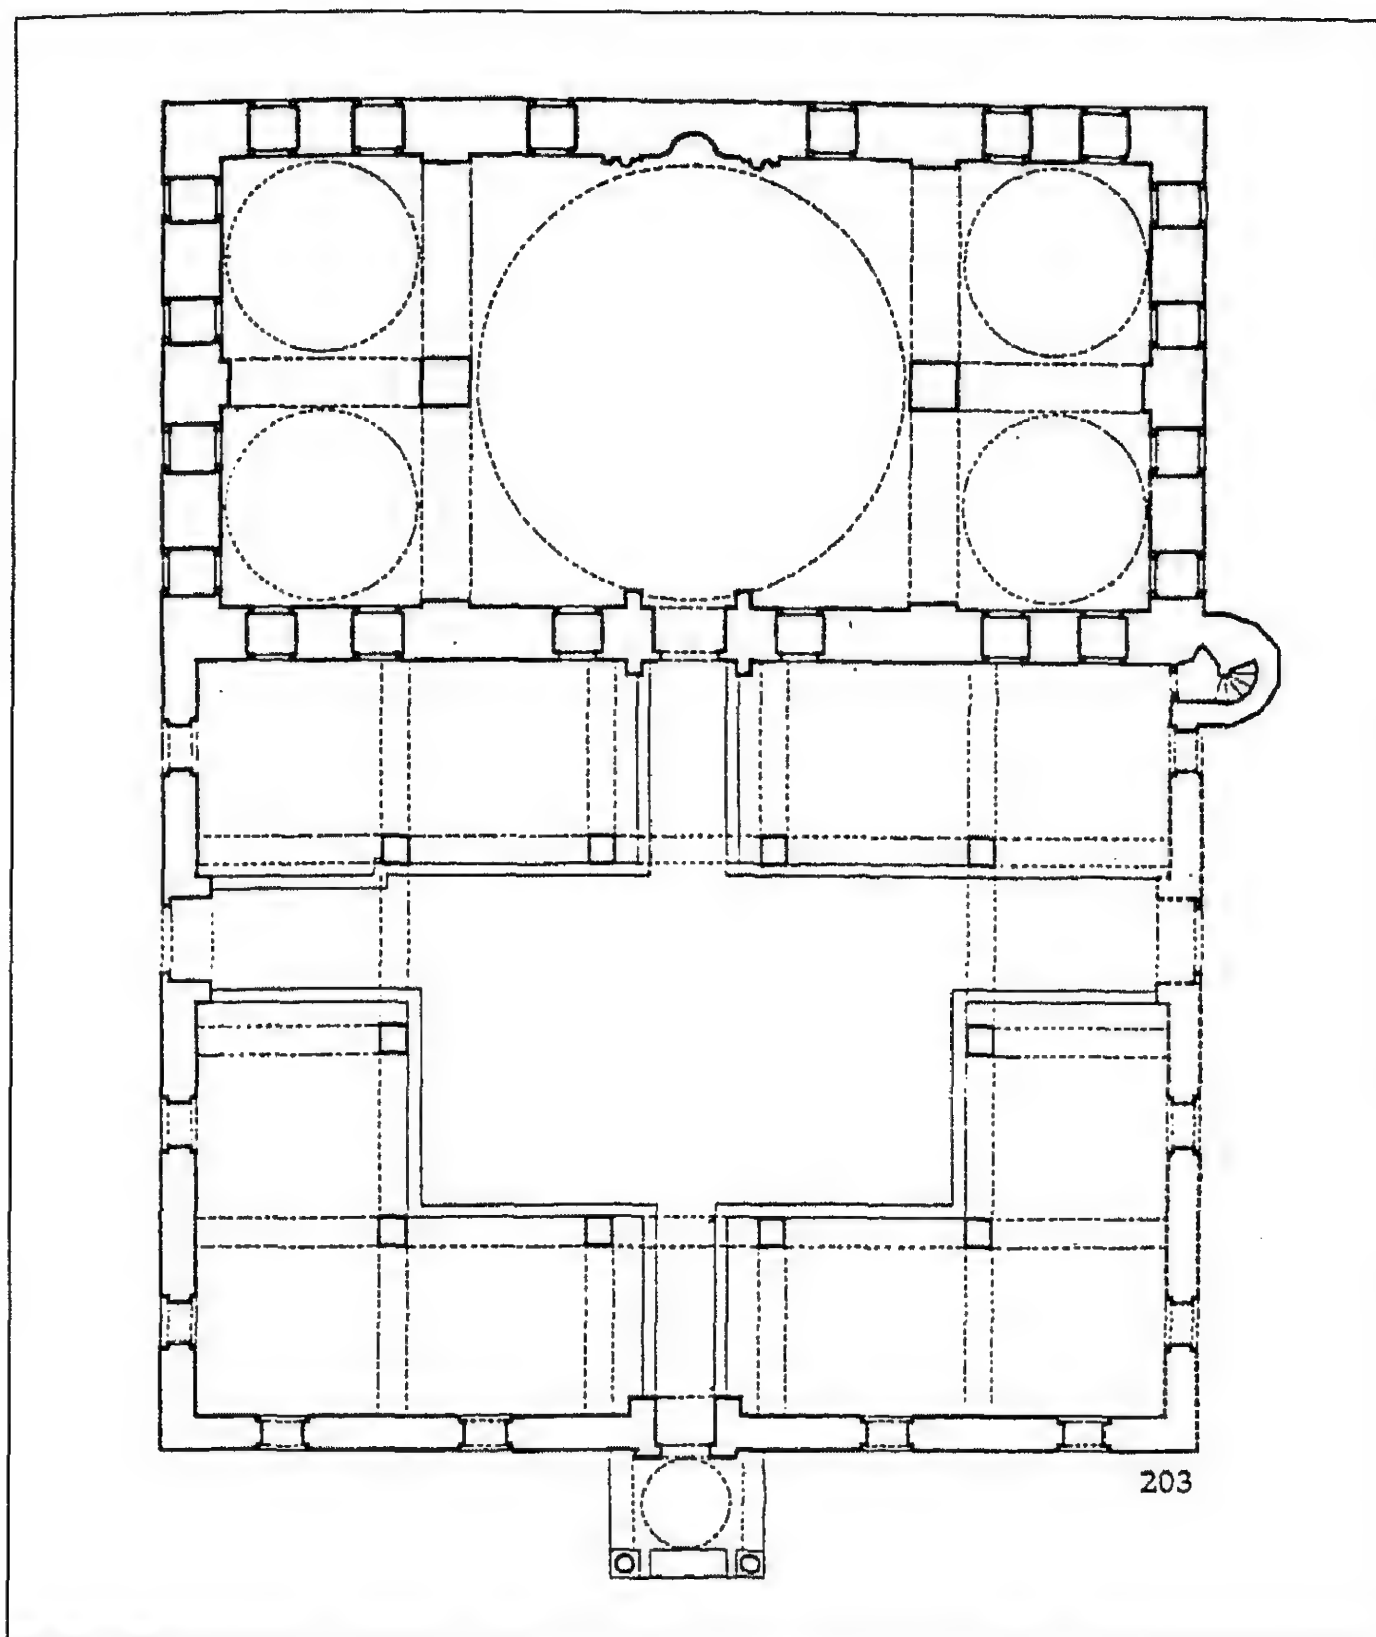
مسقط أفقي لمسجد الخان في طلاس (عن: Türkmen)
